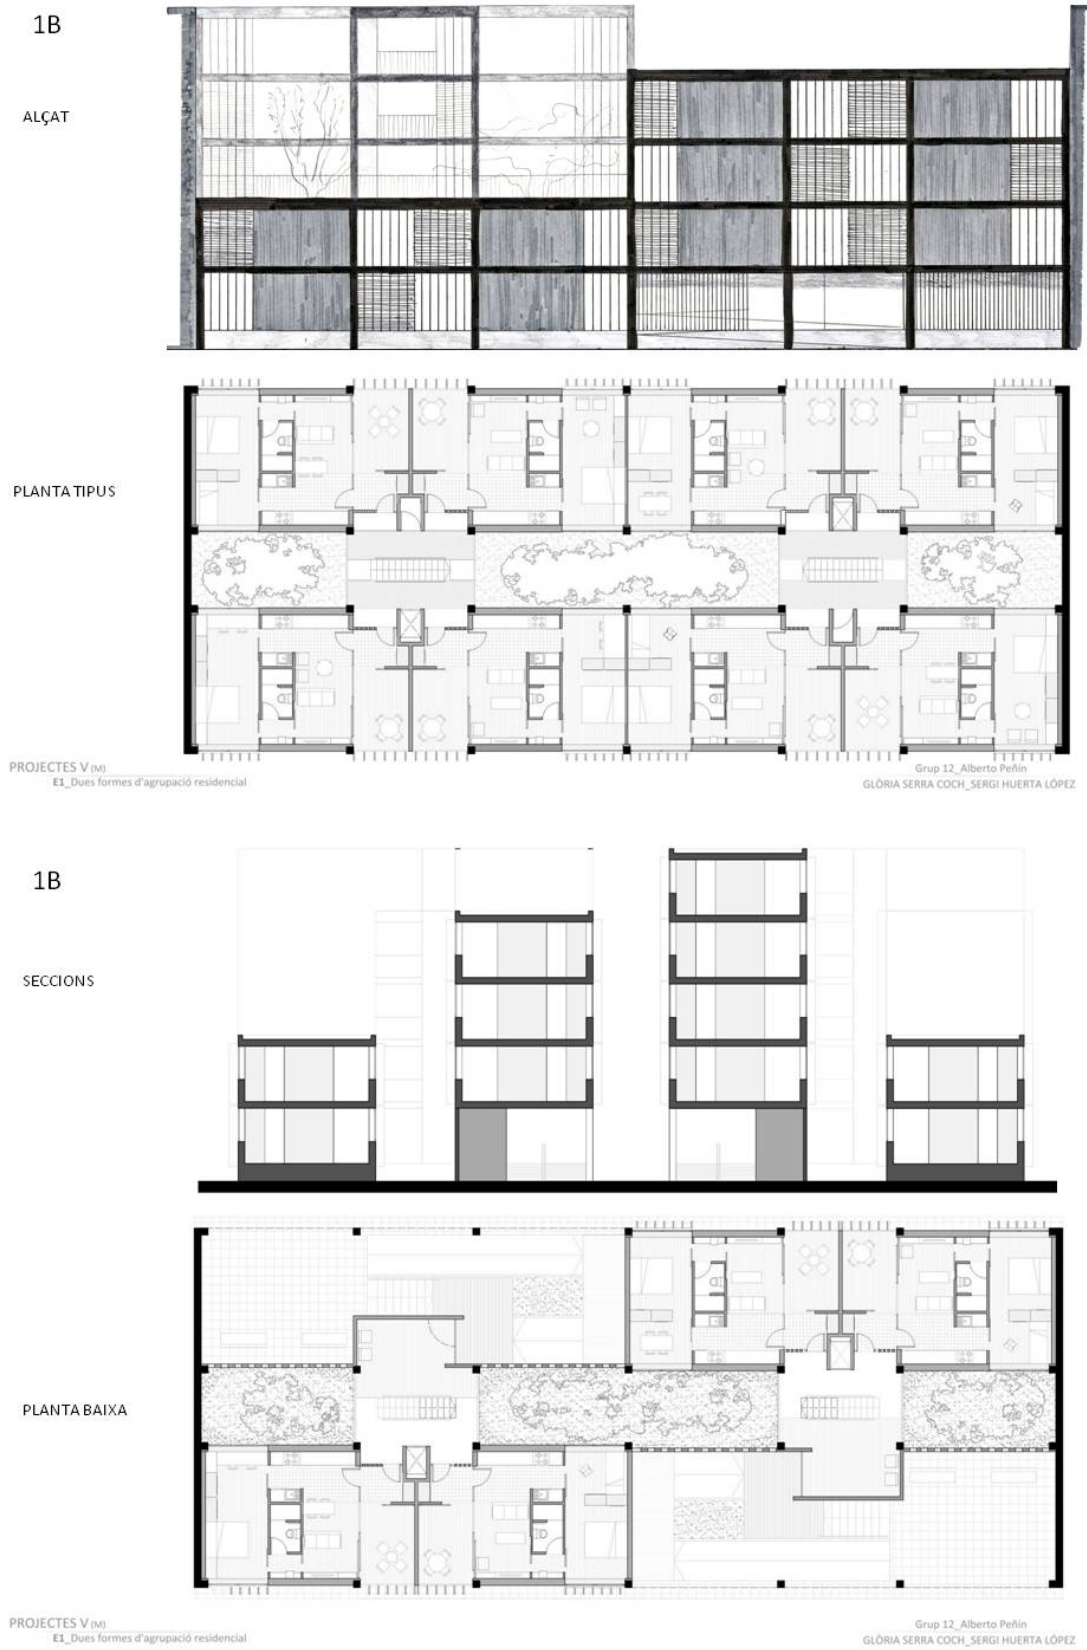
Ejercicio 1B Plantas, alzado y sección
